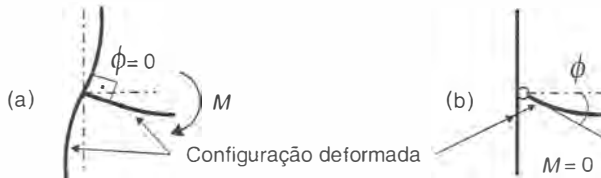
Ligações ideais: (a) ligação perfeitamente rígida; (b) ligação rotulada.
